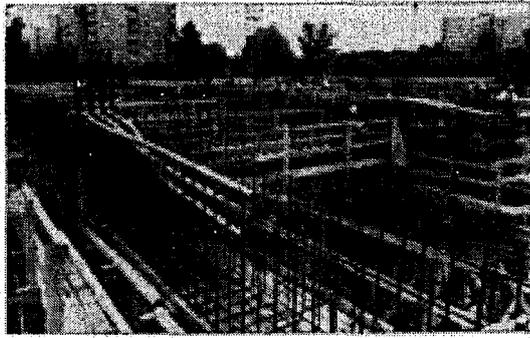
Напрягаемая арматура без сцепления с бетоном в элементах перекрытий (конструкции I группы)
